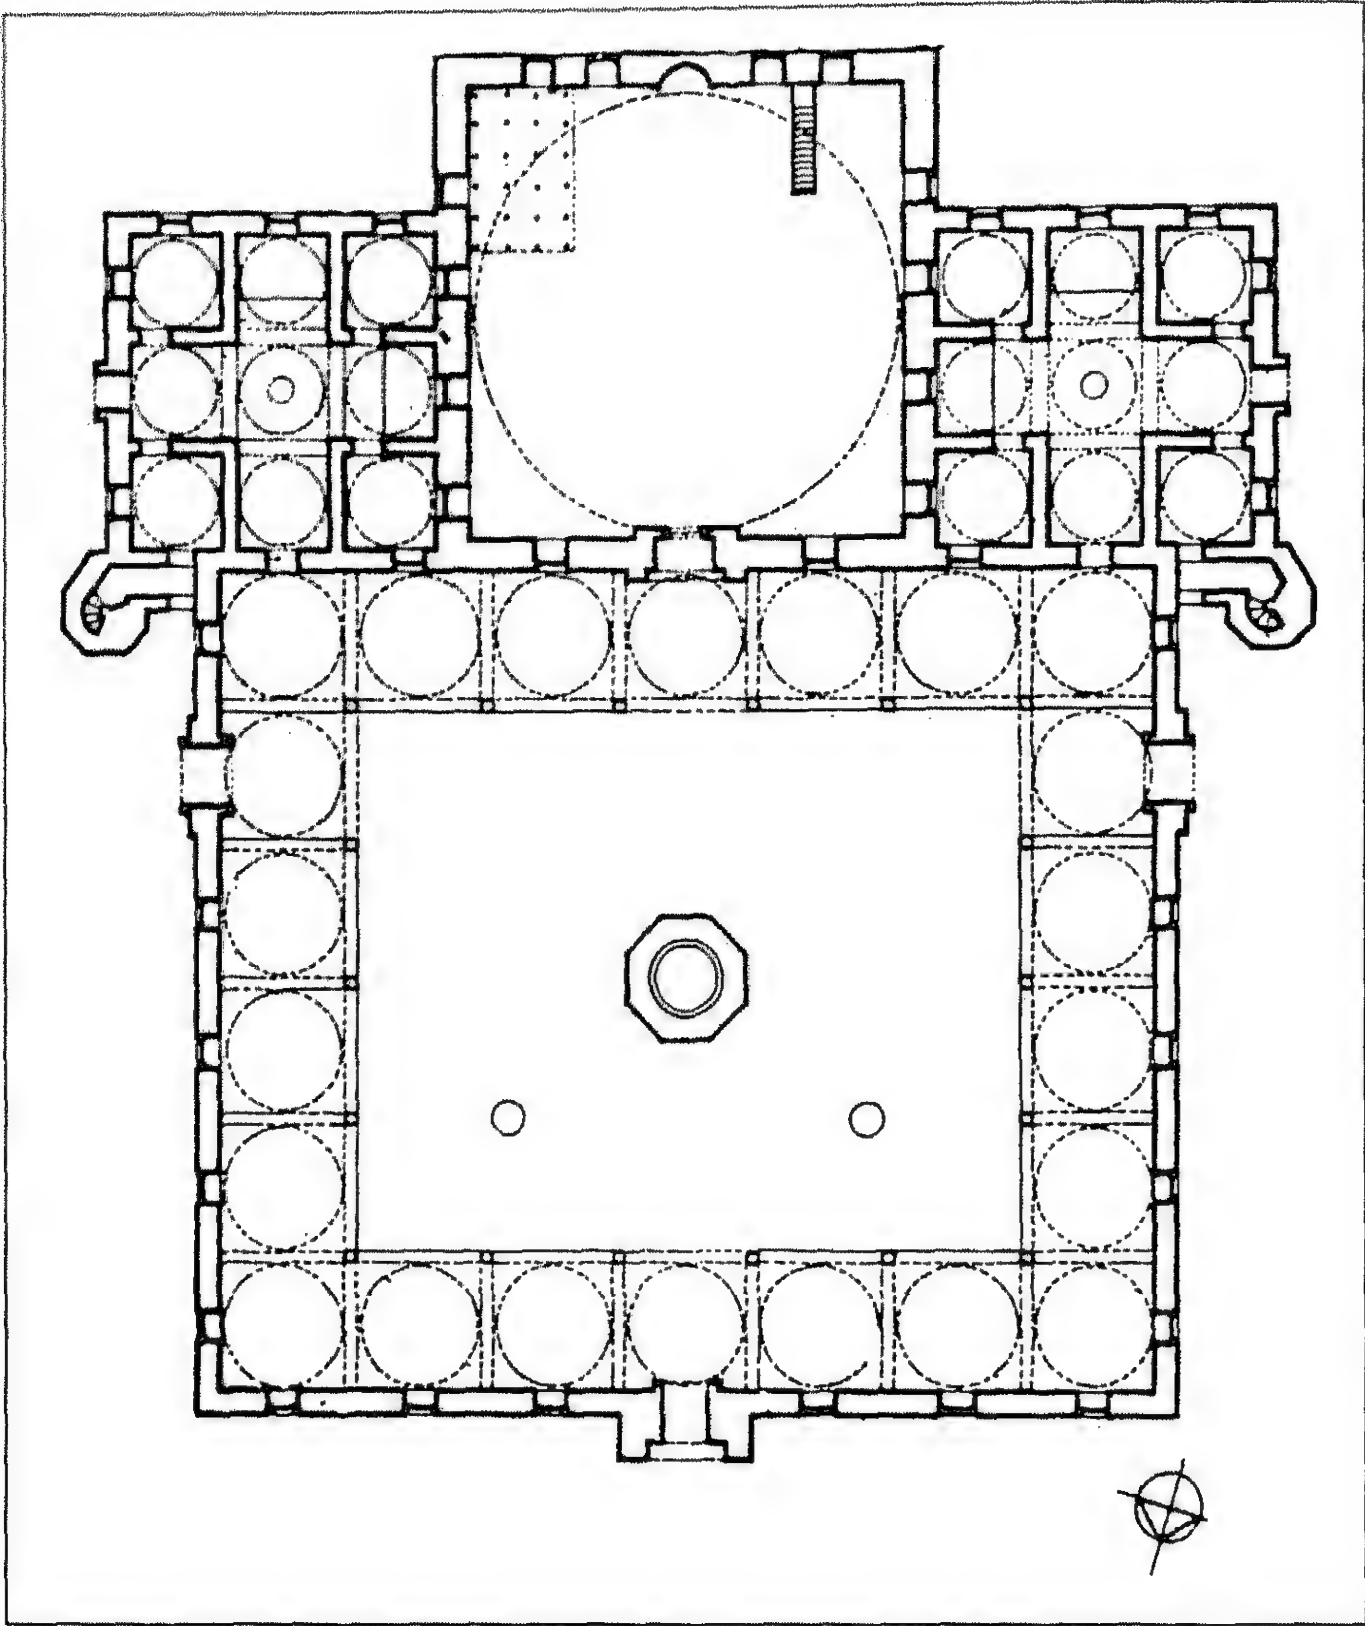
مسقط أفقي وقطاع لمسجد مراد الثاني في اسكوب (عن: ايفردى)
